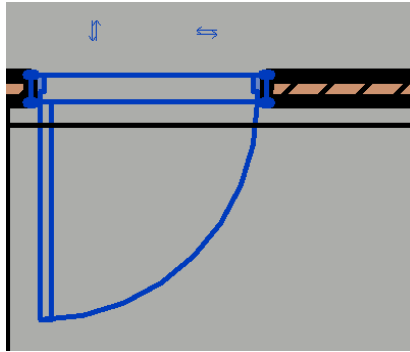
Vista en planta de una puerta y sus posibles cambios de orientación
